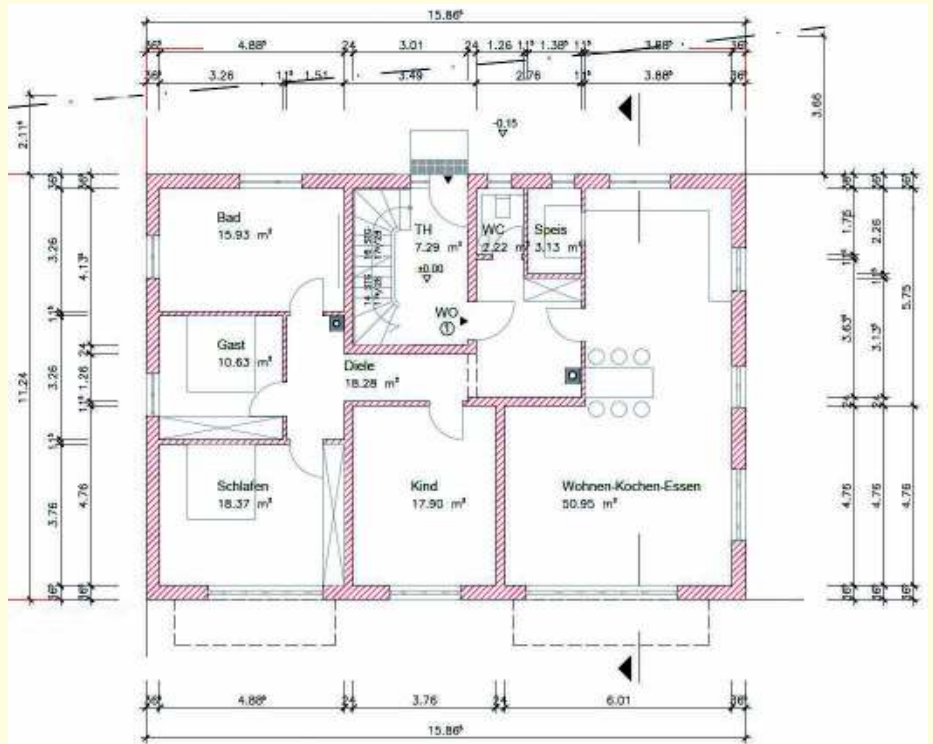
Grundriss Erdgeschoss des Mehrfamilienhauses [6]
